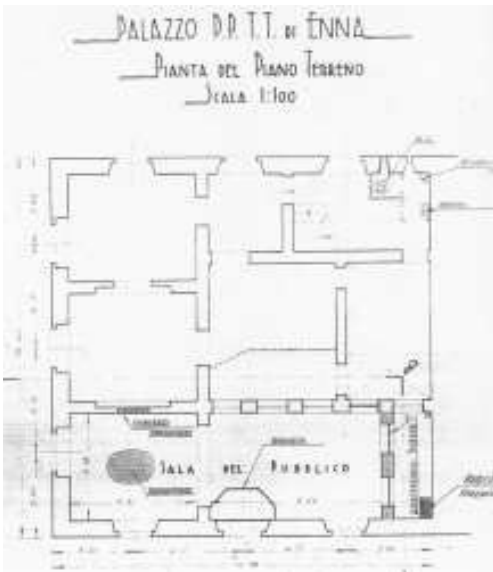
Grundriss des Palazzo in Enna (1935)
